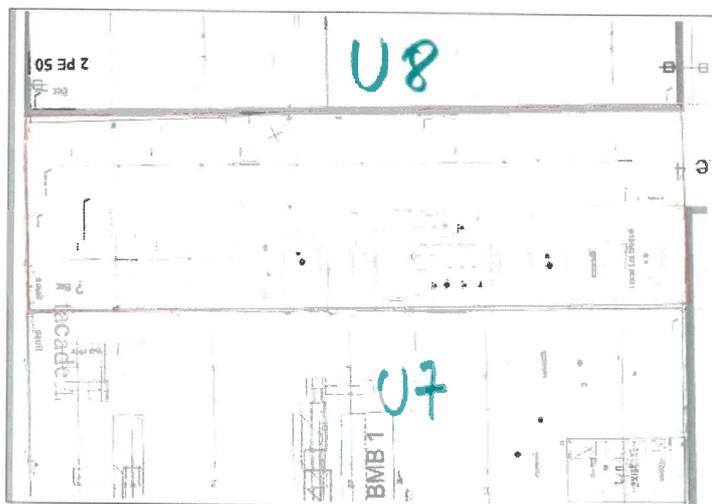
plan de la zone entre U7 et U8 (zone entourée d'un trait rouge)
